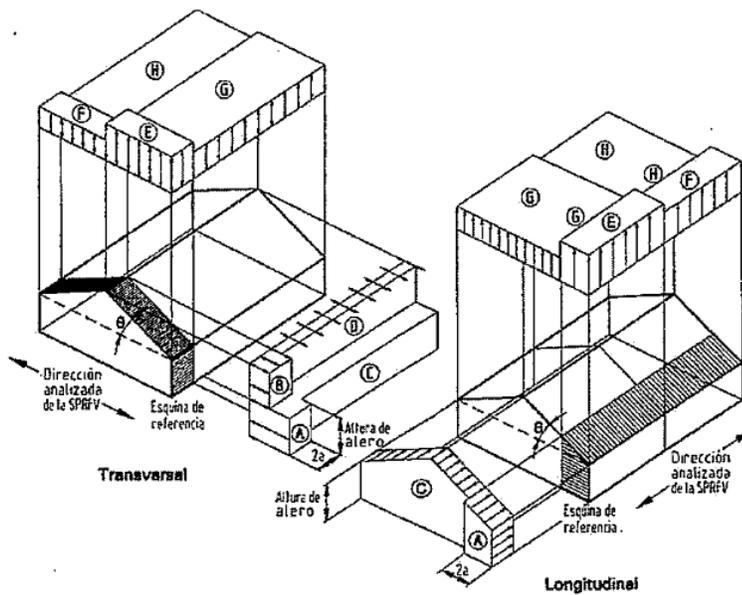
Representación de las zonas de aplicación de las cargas de viento.
